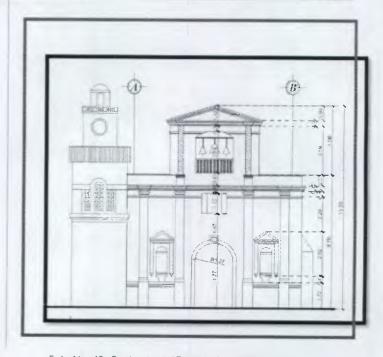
Fachada del Templo San Felipe Apóstol. Jackeline González.
